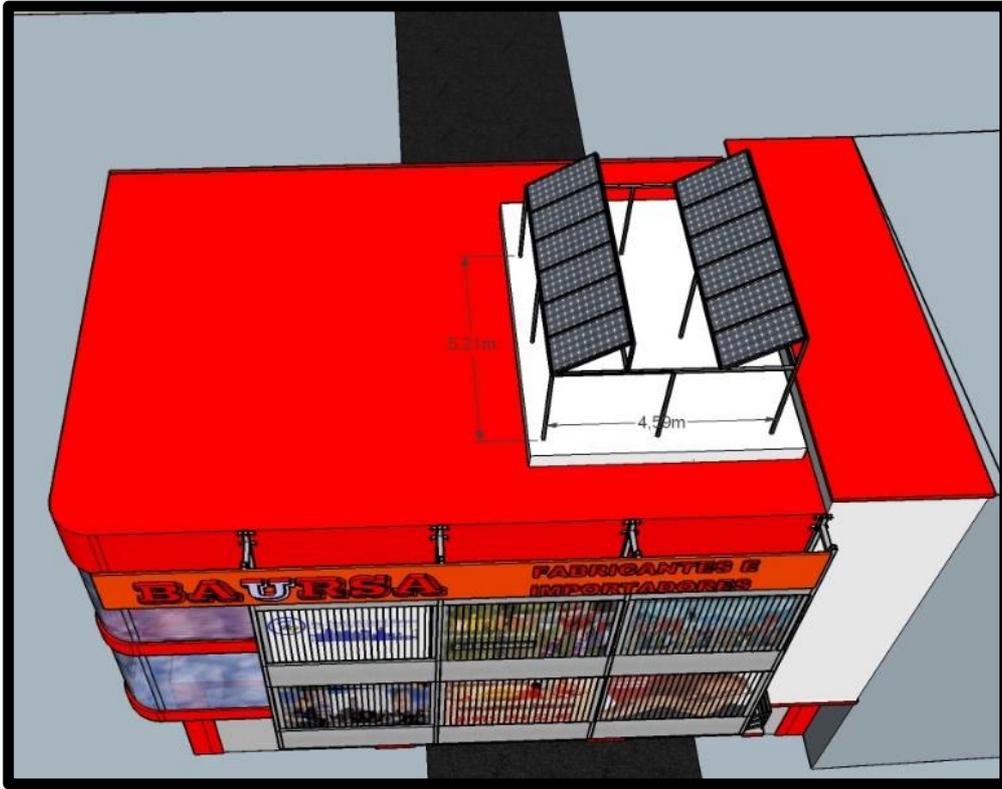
Edificio con sistema de doble fachada, vista aérea.
